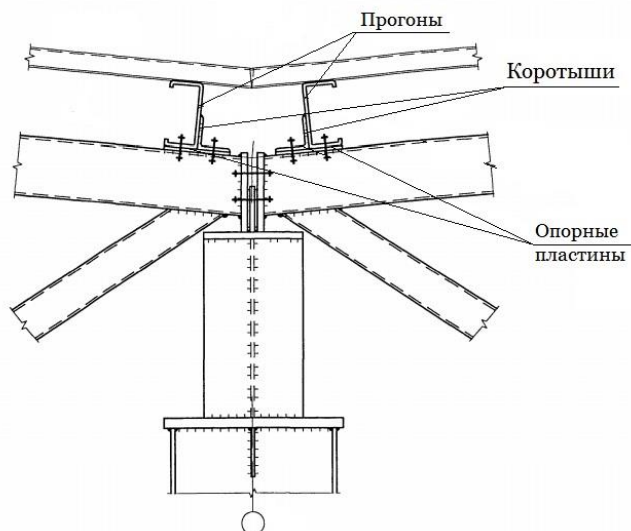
Конструкция узла опирания стальных прогонов на верхний пояс ферм по серии 1.460.3-23.98 [1]
